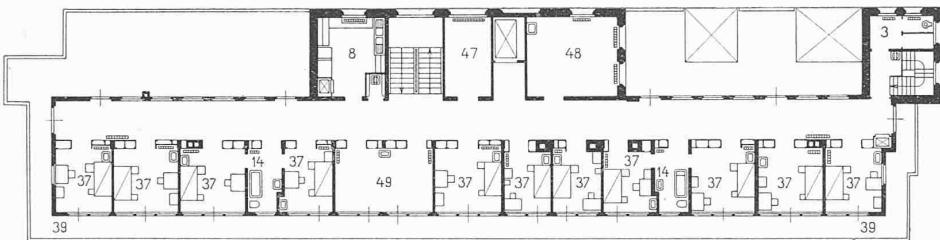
Grundriss vom II. Stock. — Masstab 1 : 400.
